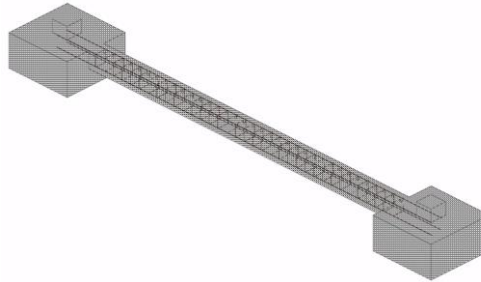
Vista 3D de la viga de atado C.1.1 [N13-N9]
